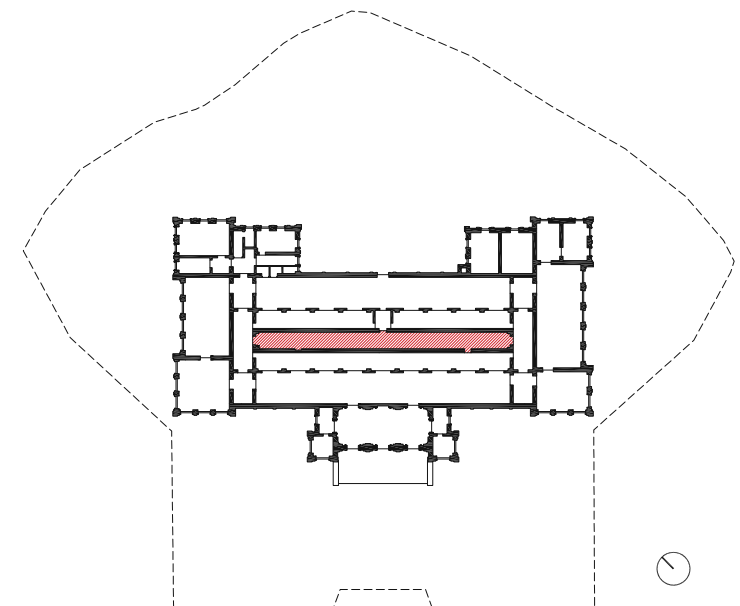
Planausschnitt Mittelgang mit Oberlicht | BVA
